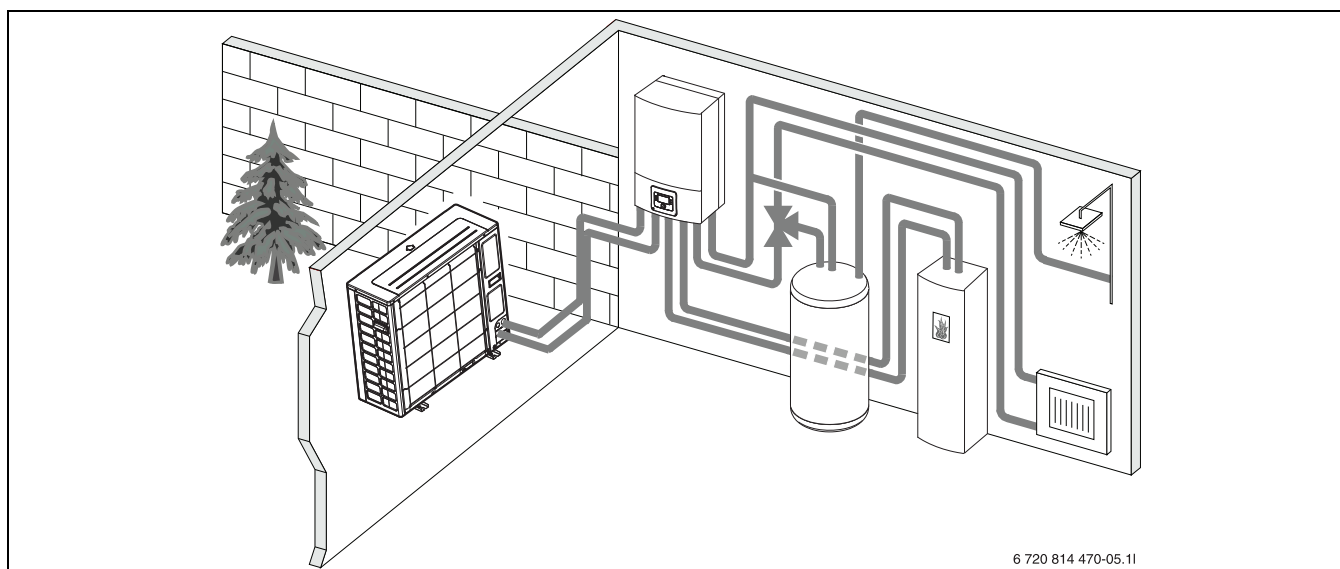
Тепловой насос, наружный блок, внутренний блок AWBS без дополнительного электронагревателя, внешний бак-водонагреватель и внешний дополнительный нагревательный элемент
